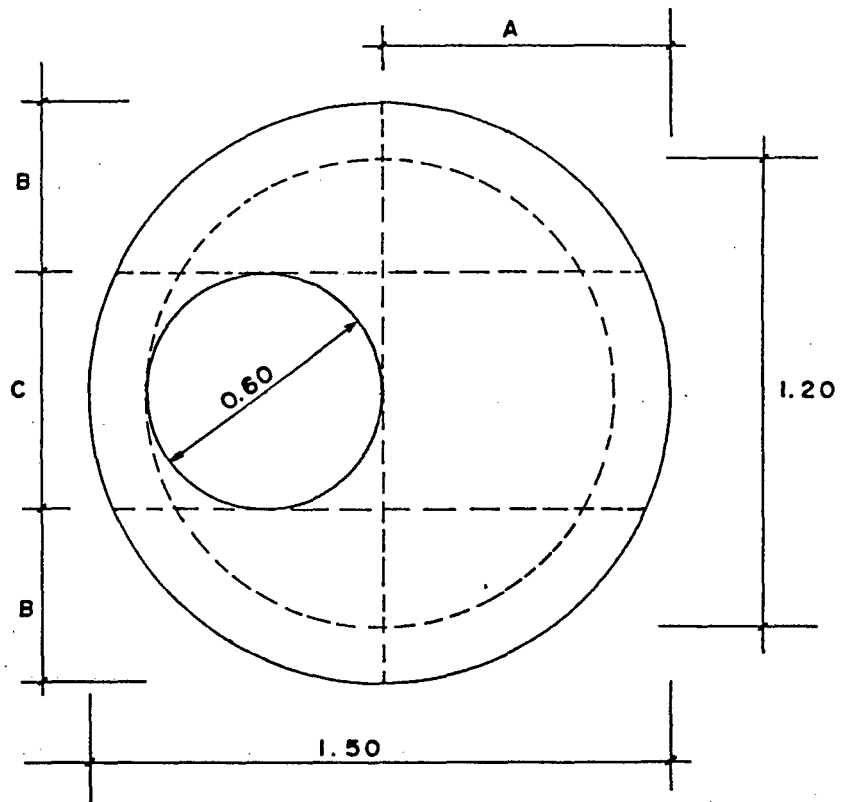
REFUERZO EN LOSA DE TECHO EN BUZONES
